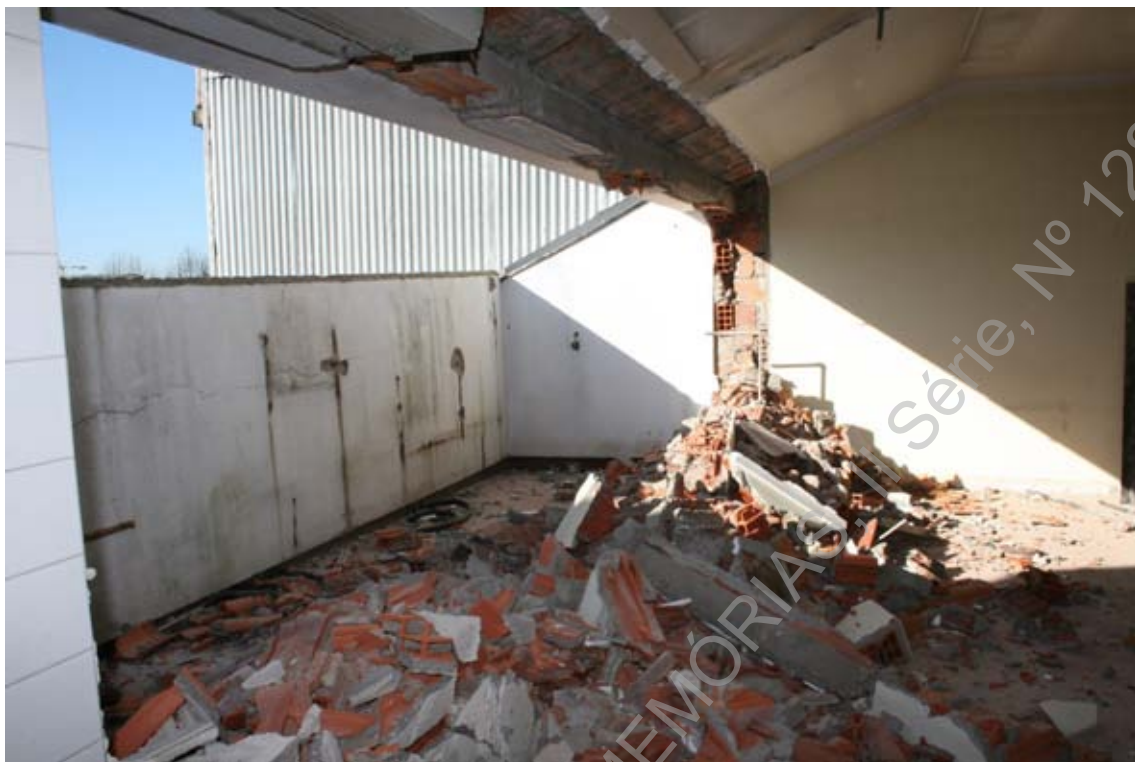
(IMG_5582) – Pormenor do acompanhamento da demolição de parede interna do edifício localizado na Avenida Central n.ºs 157-163, Braga.
